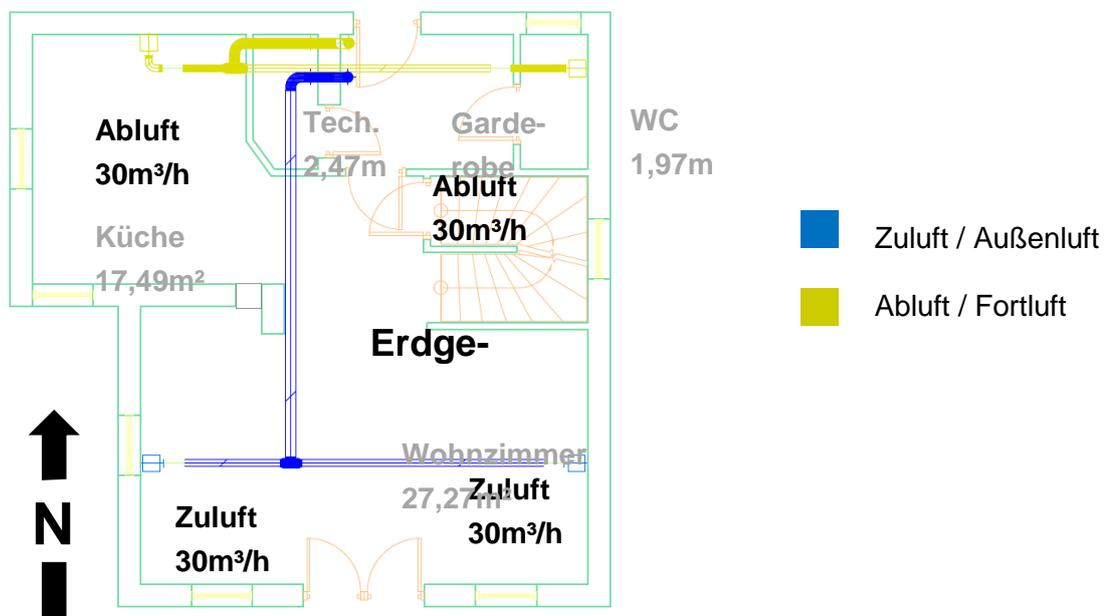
Leitungsschema Musterhaus Erdgeschoss
